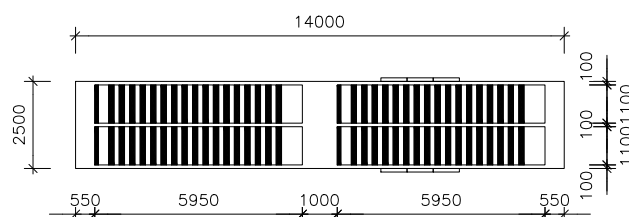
Doprava prefabrikovaných schodišťových ramen [7]
